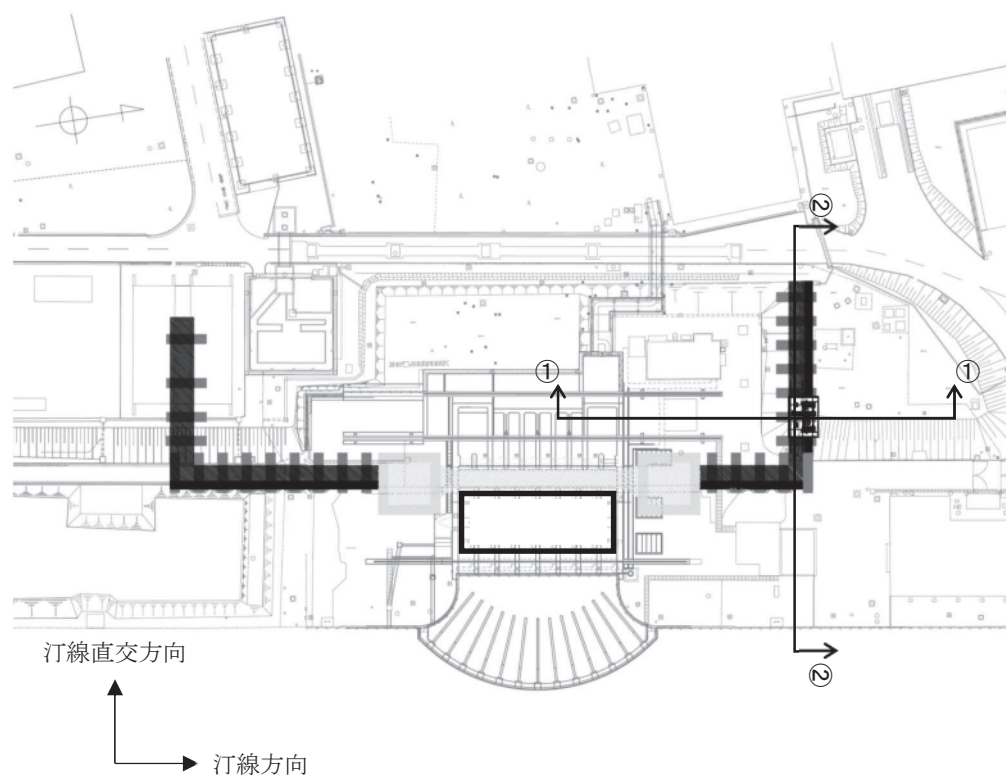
(1) 防潮堤（鉄筋コンクリート防潮壁）の平面図
